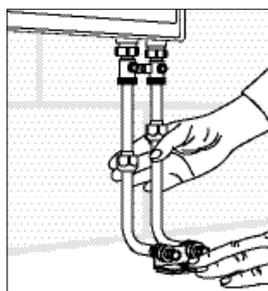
Posicionar el kit de codos de conexión a radiador
